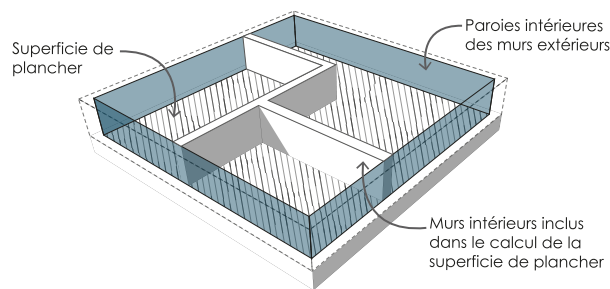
Mesure de la superficie de plancher d'un bâtiment
